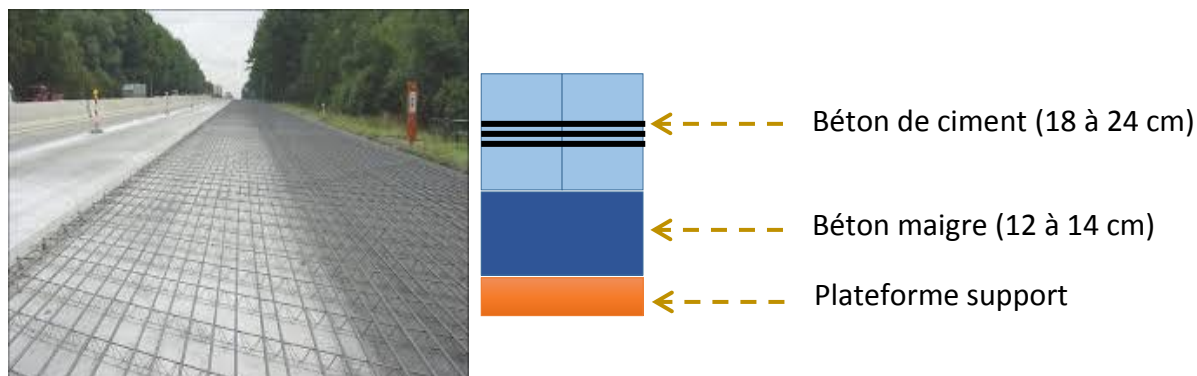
Chaussées à dalles armées et à joints goujonnées
